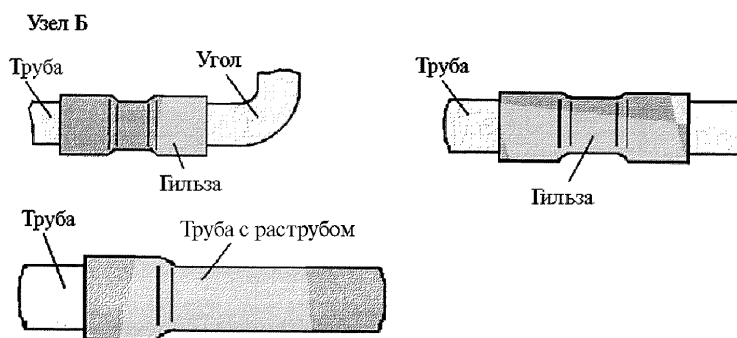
Открытая прокладка пластмассовых труб
